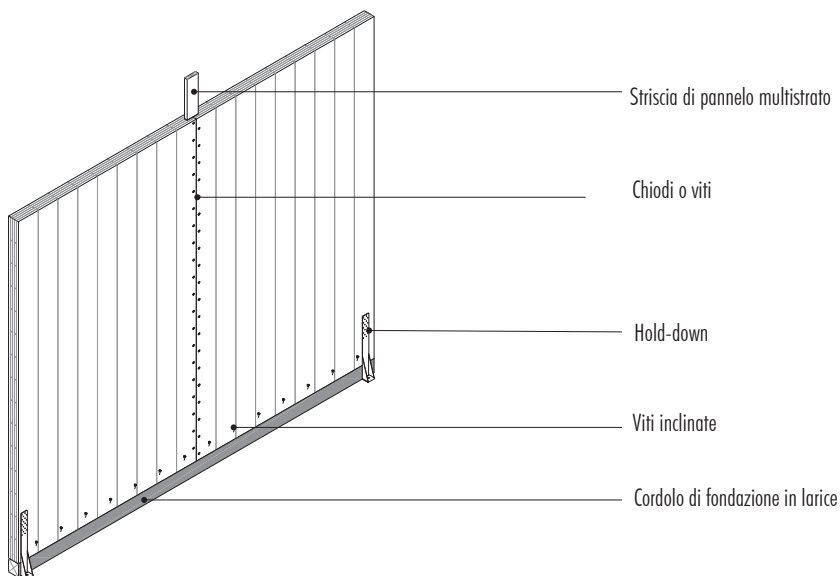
Dettaglio di una parete XLam con giunto verticale tra i pannelli tramite viti autoforanti o chiodi.
